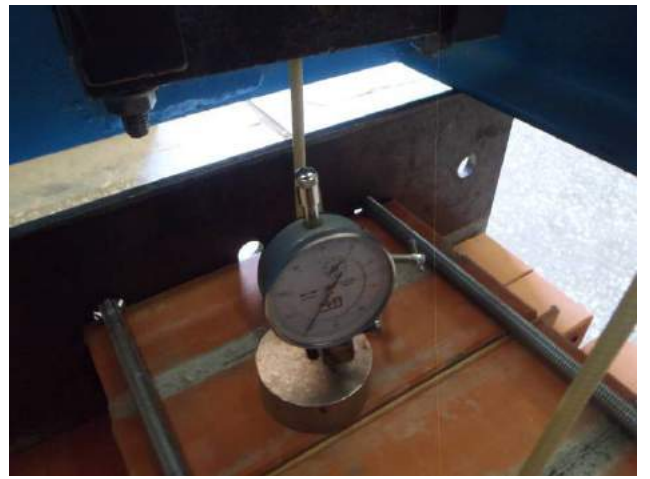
Индикатор часового типа для контроля перемещений при загрузении элементов испытываемых образцов.
